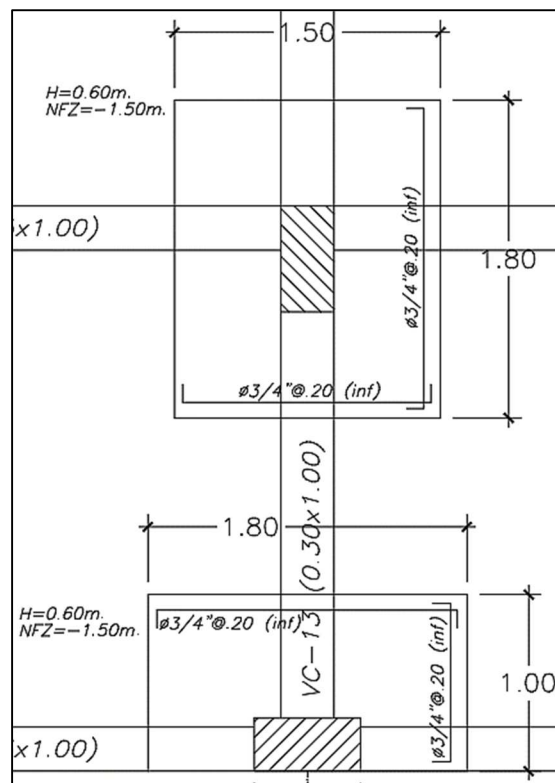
Vista en planta del diseño final de las zapatas conectadas
